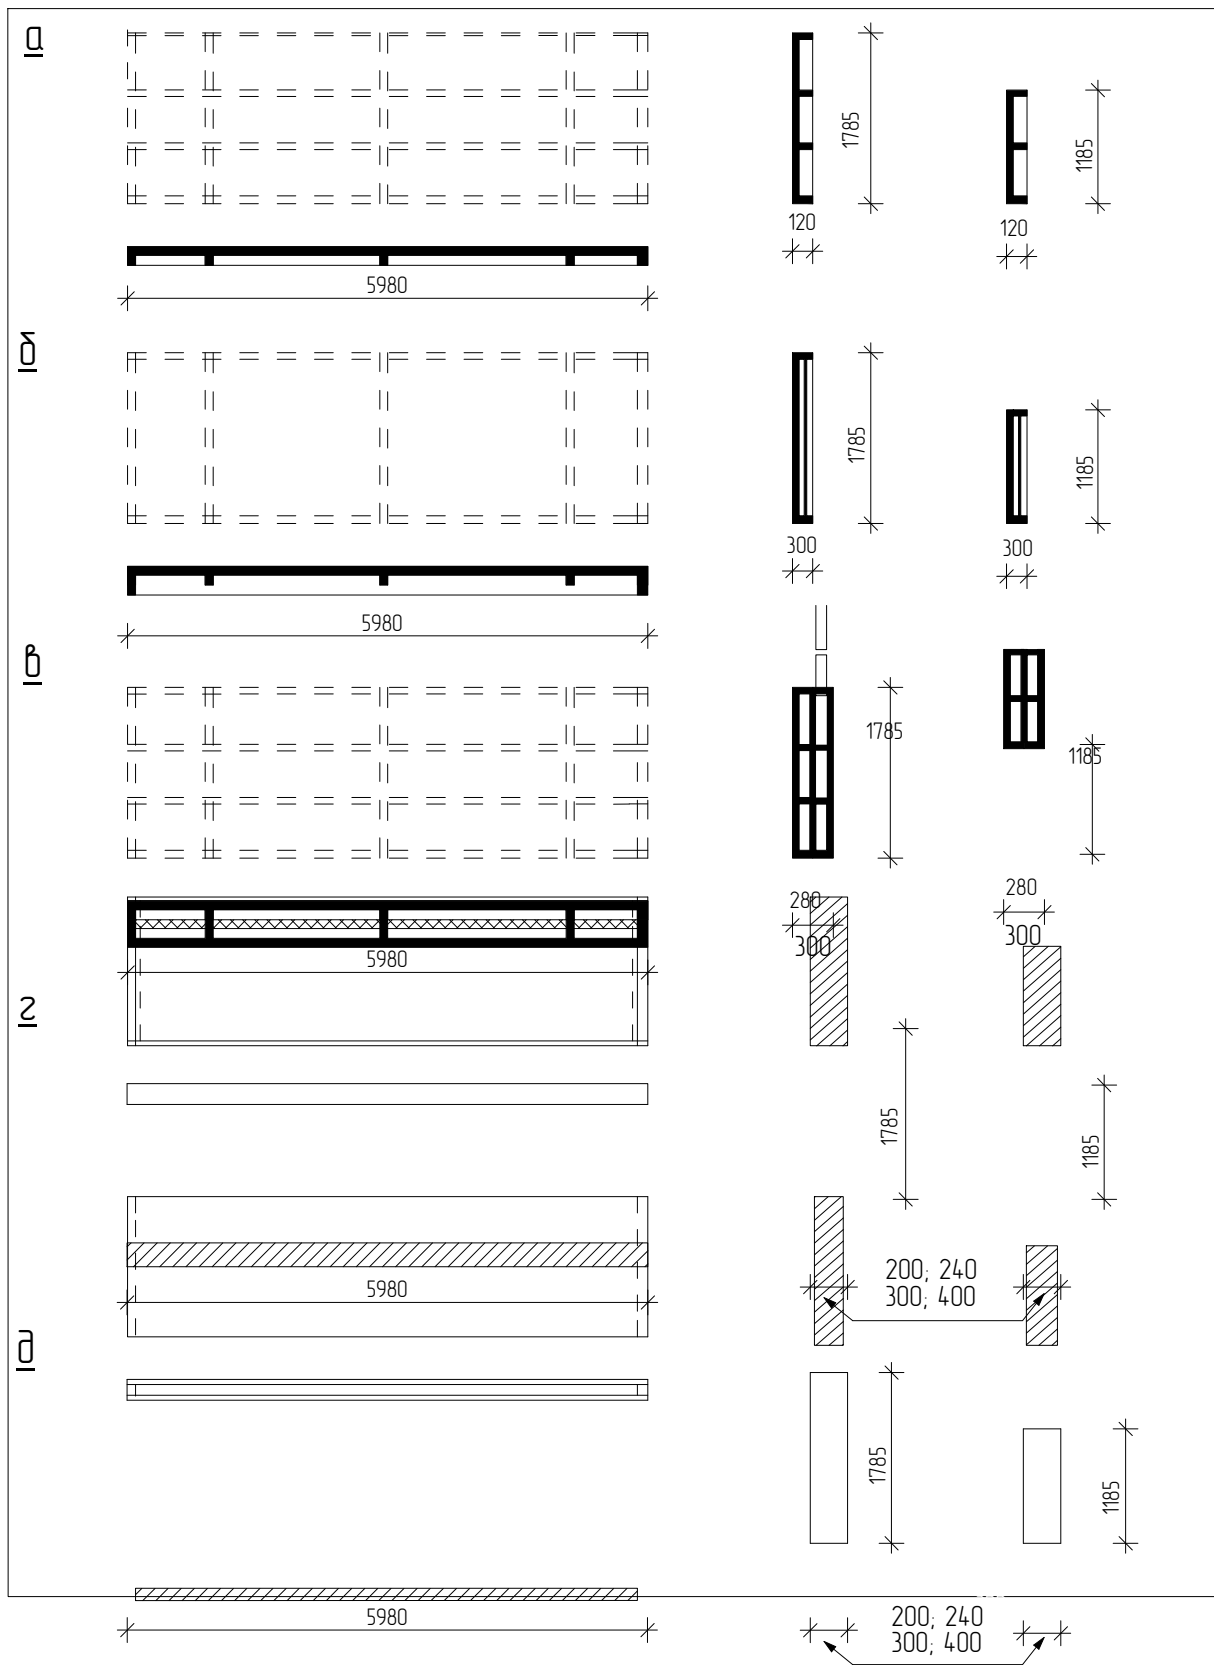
Стінні панелі а і б – залізобетонні для неопалюваних будівель, в – залізобетонні триколонні для опалюваних будівель, г – з ніздрюватих бетонів, д – з легких бетонів
